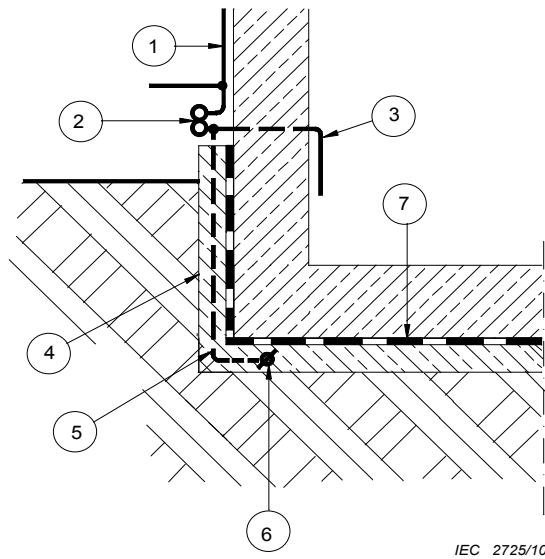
Fondation isolée avec prise de terre à fond de fouille dans une couche en béton non armé sous l'isolation bitumée
